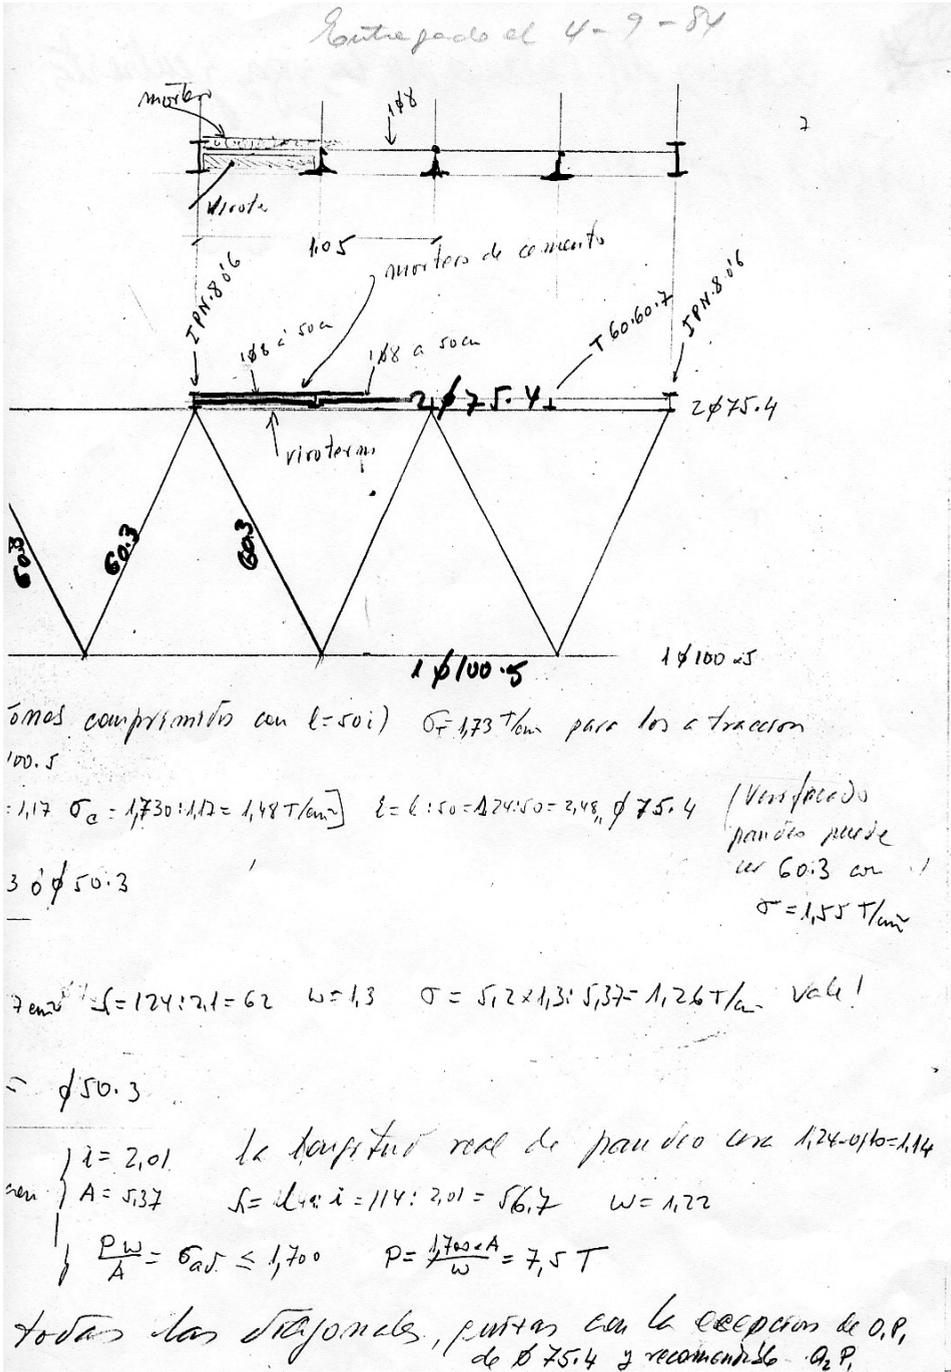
Croquis del cálculo de las vigas y cubierta.
